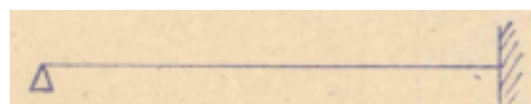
Schema statico trave principale solaio a quota 4,4m, (Nervi, Calcoli statici, padiglione 2, 1947)
